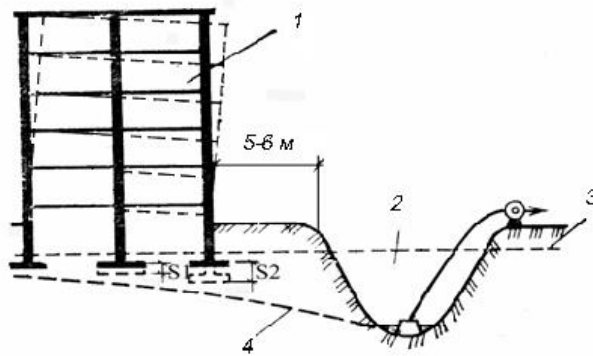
Деформація житлового будинку, викликана відкритим водовідливом з суміжної з ним траншеї: 1 – житловий будинок; 2 – траншея; 3 – рівень підземних вод до відкачування; 4 – те саме, після відкачування
